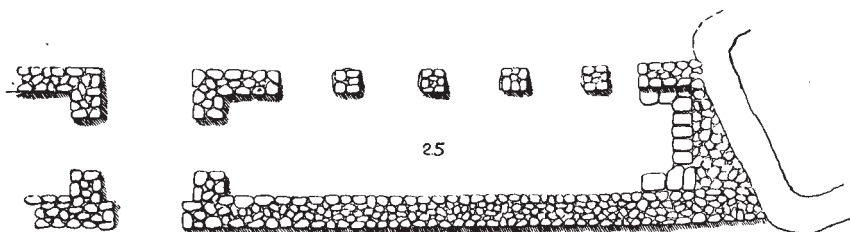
Recinto delle Feste: *planimetria del porticato*.
